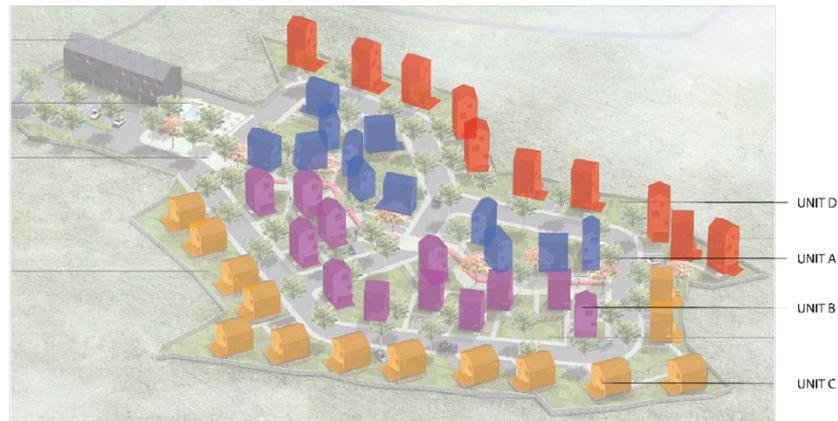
Denah sirkulasi Hadohilljo Townhouse
